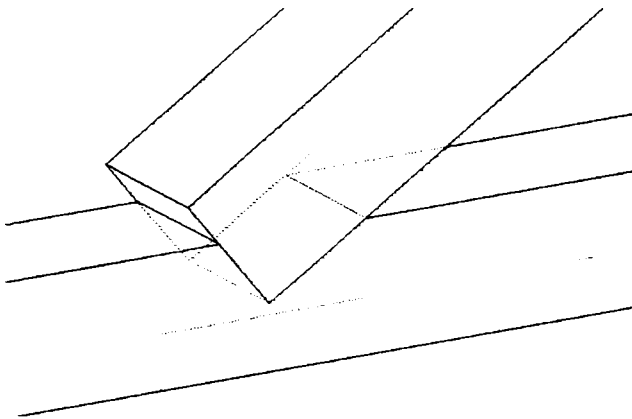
Eclisare frontală cu tăierea frontală perpendiculară
